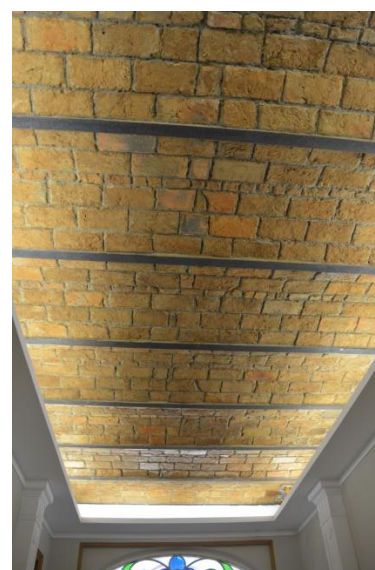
Vista do sistema construtivo da laje da Casa 01.
